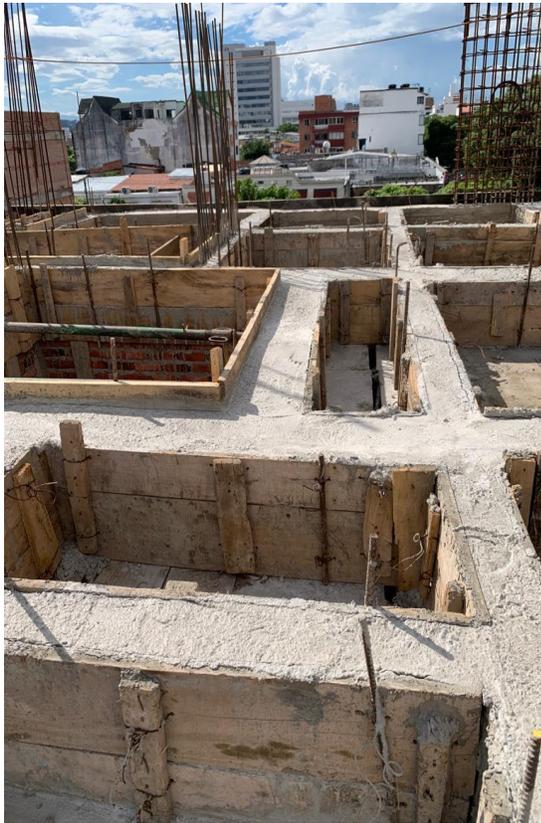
Desencofrado de vigas secundarias ejes D-E Edificio Wiedii
